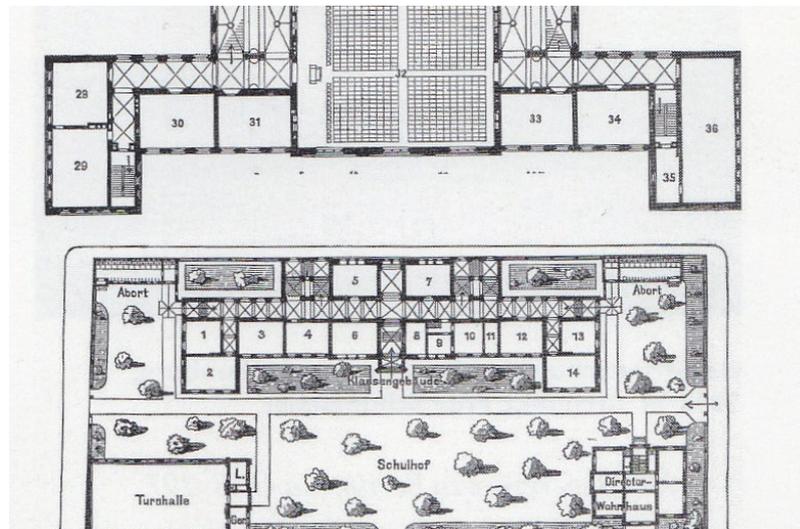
Grundriss Gemeindedoppelschule Pflugstraße in Berlin, 1889/90
